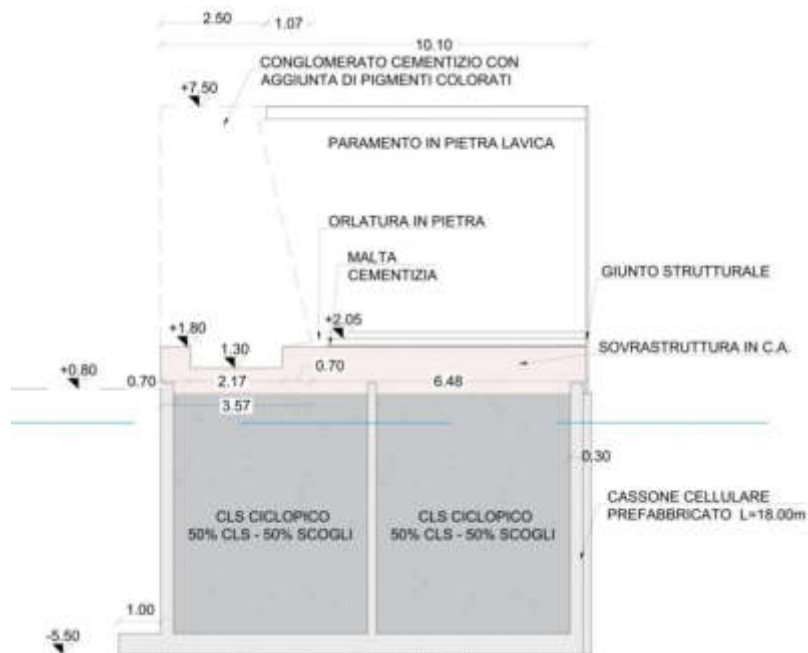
Sezione trasversale cassone di testata lato mare – sovrastruttura - muro paraonde.
